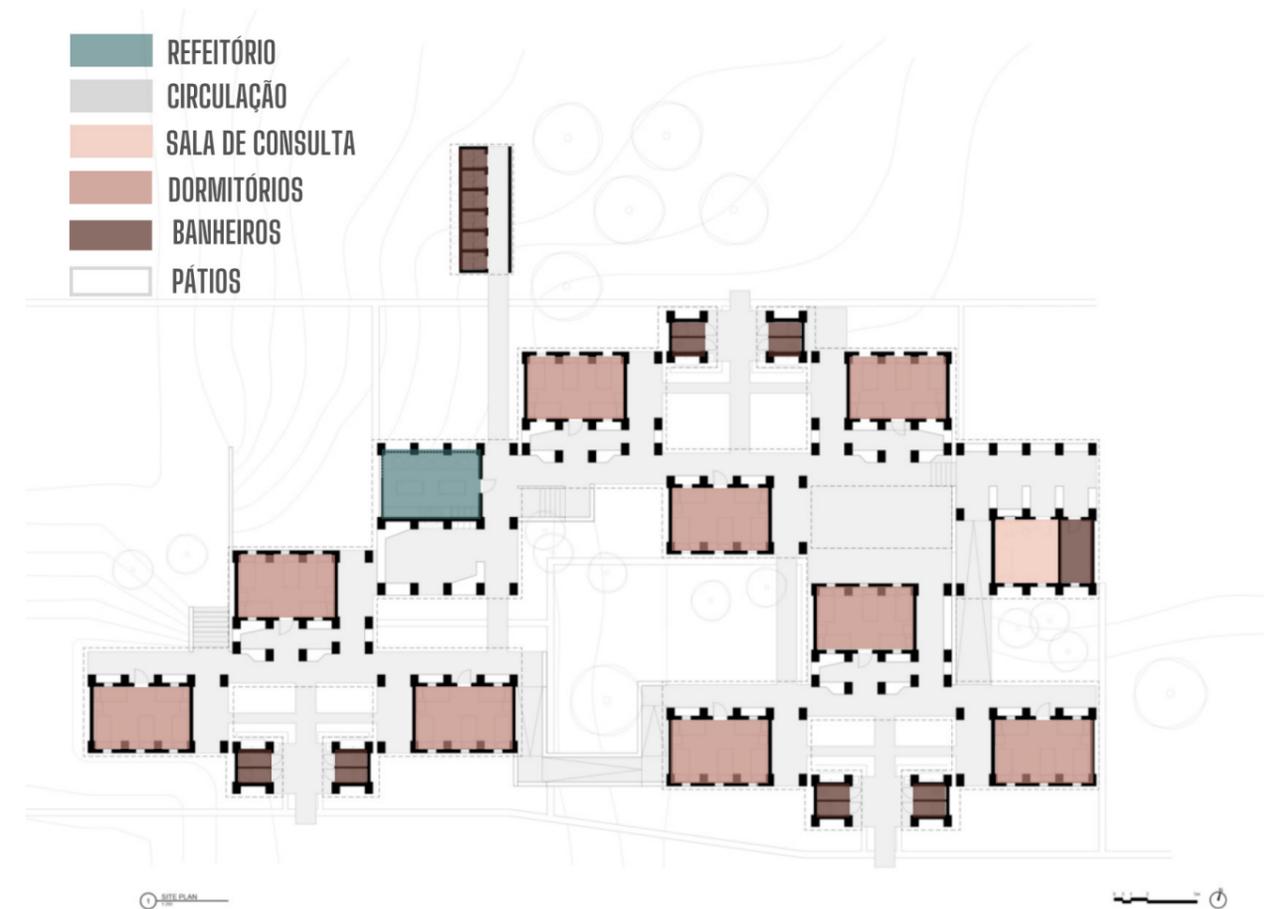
Planta Baixa setorizada do Centro para Gestantes.
